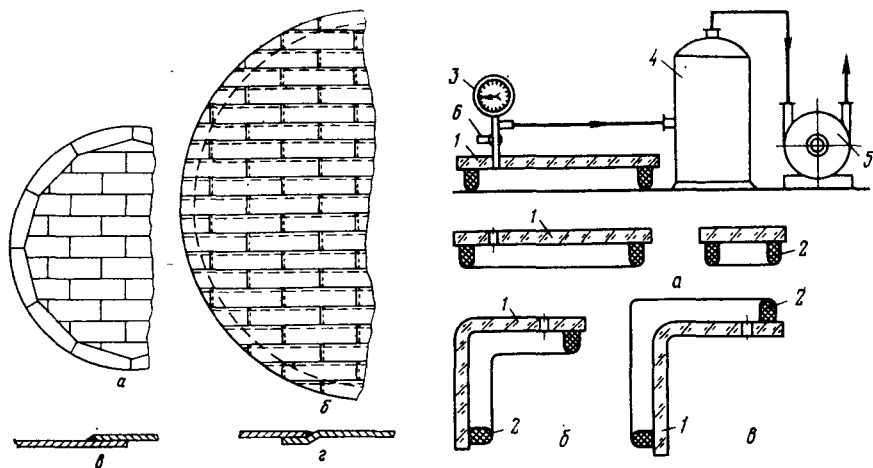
Конструкции днищ вертикальных цилиндрических резервуаров: а — с окрайками (обрамляющими листами); б — без окрайков; в, г — виды сварных швов
